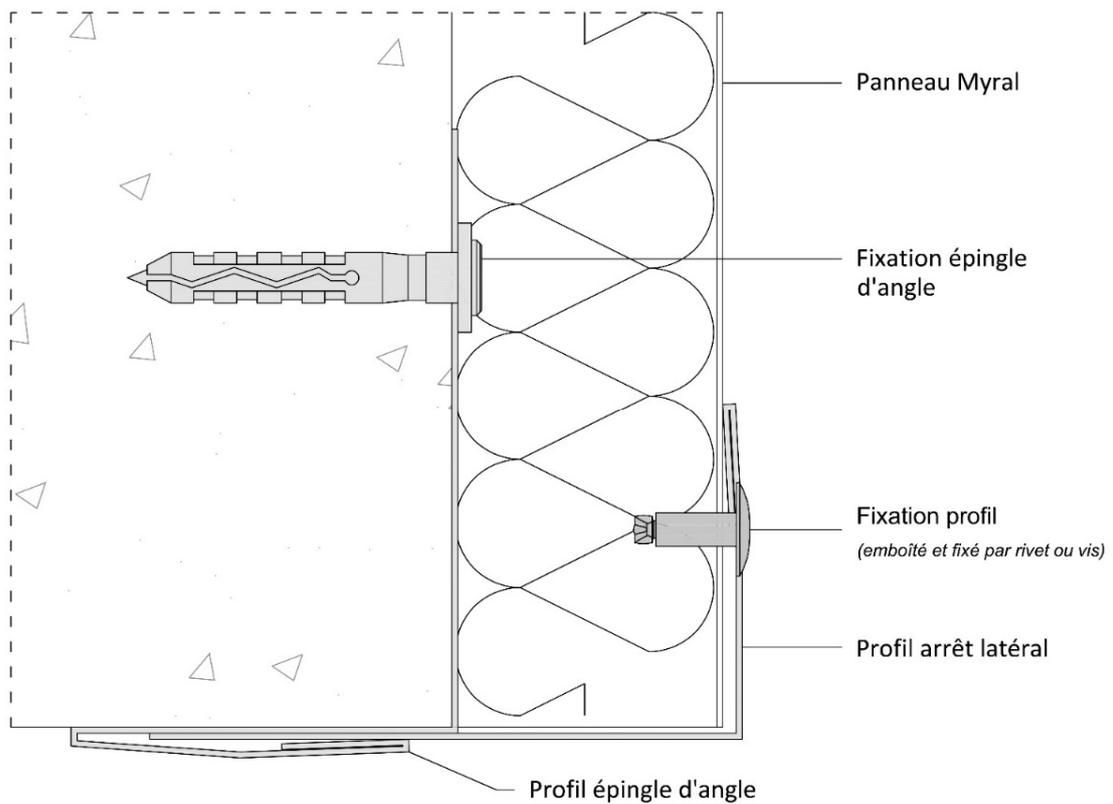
Haut de façade avec nez de dalle saillant – Pose en vêtage (coupe verticale)
